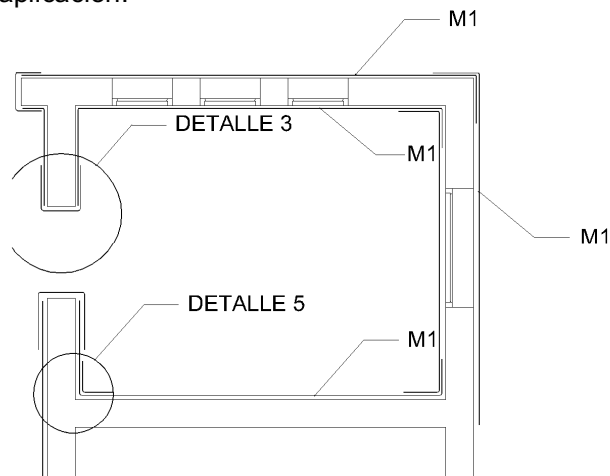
Detalle incluido en planos del refuerzo de muros con malla electrosoldada. (M1 en Figura 14, Detalles 3 y 5 en Figura 15)
